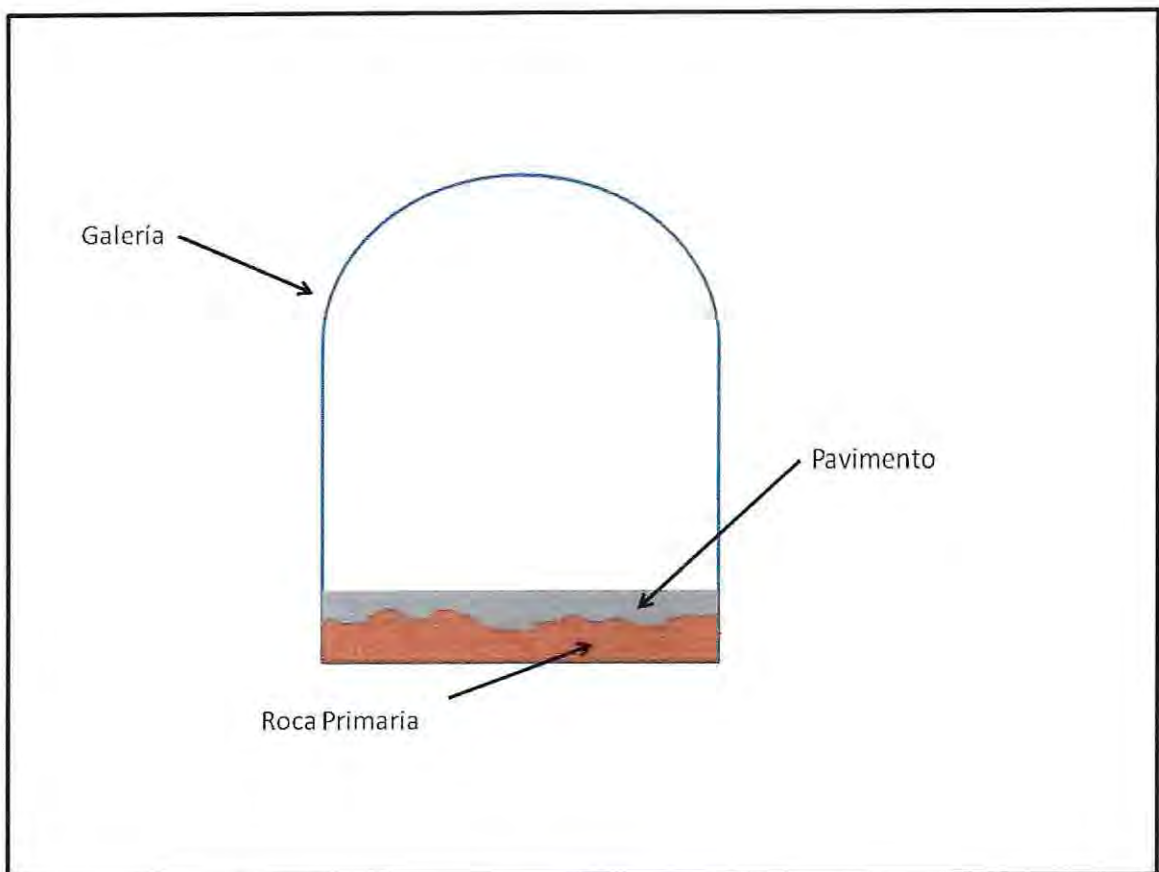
"Sección tipo, Calle Nivel de Producción, mina Esmeralda"
